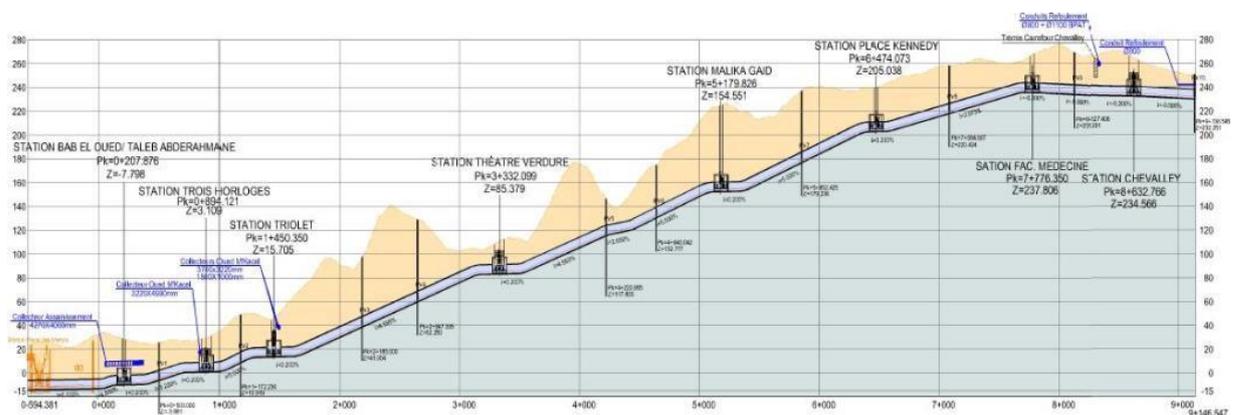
Profil sur les 8 stations, pente maximale 5%
